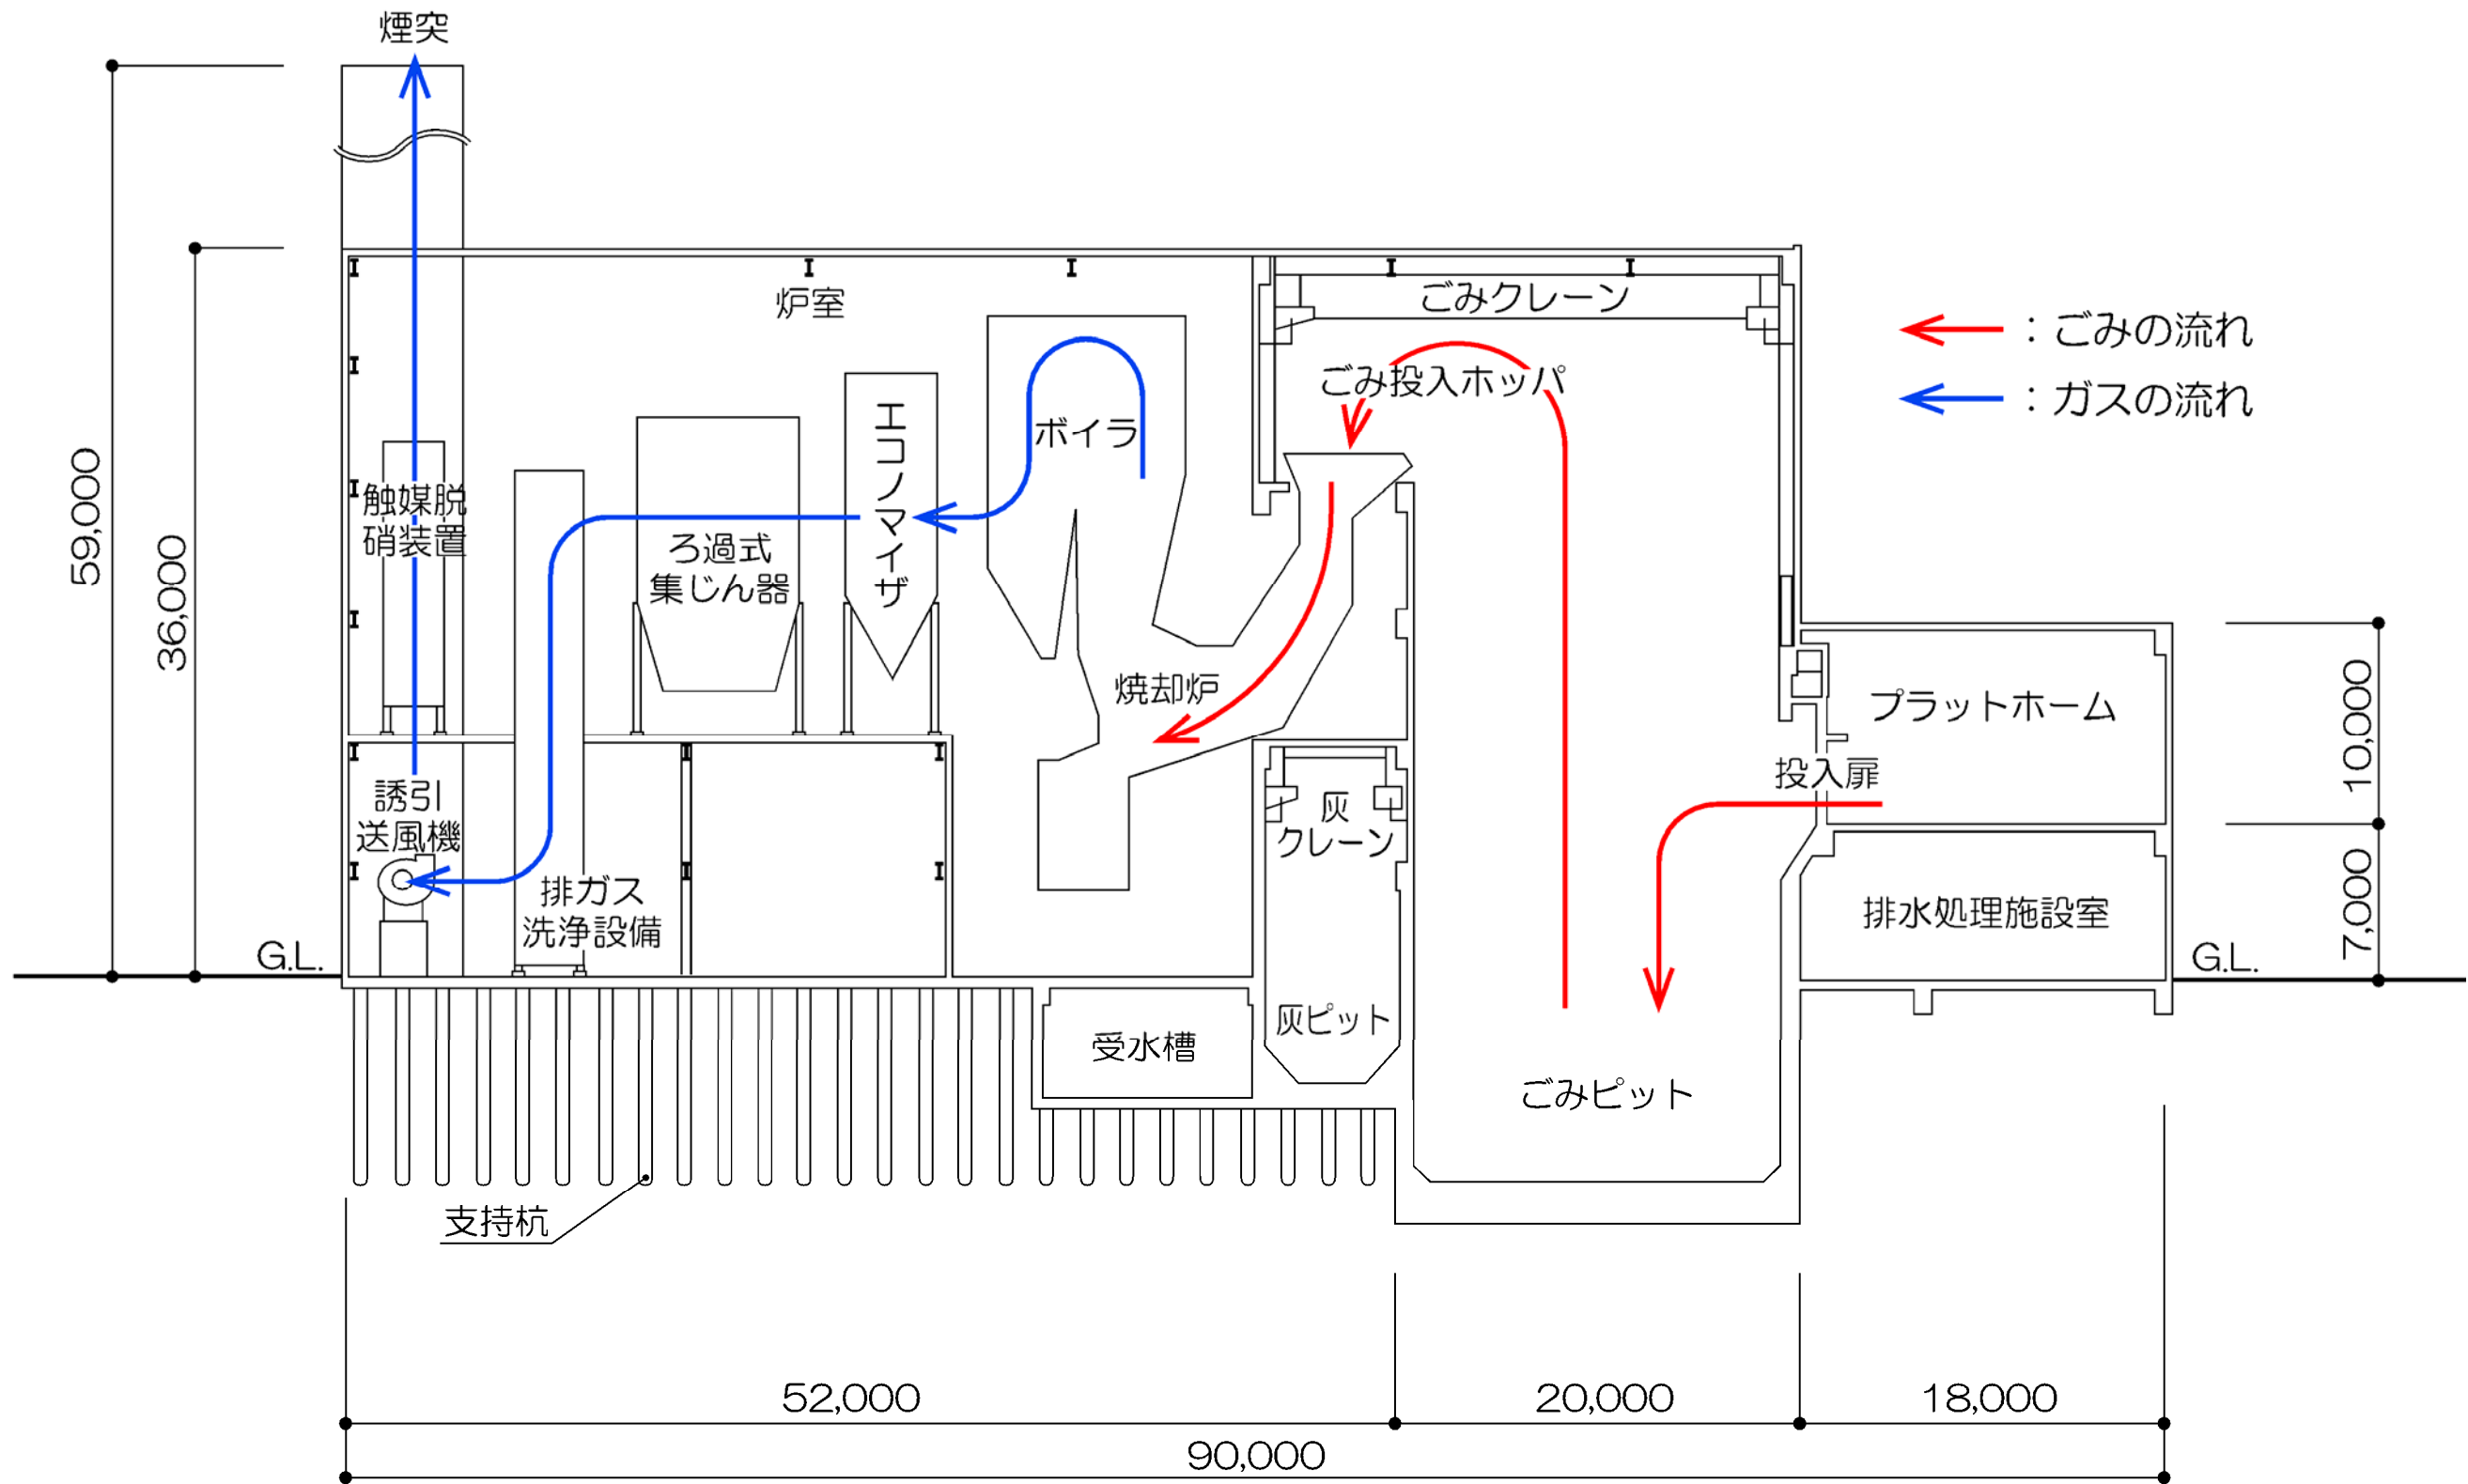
機器配置標準断面図 A-A' (本施設)
